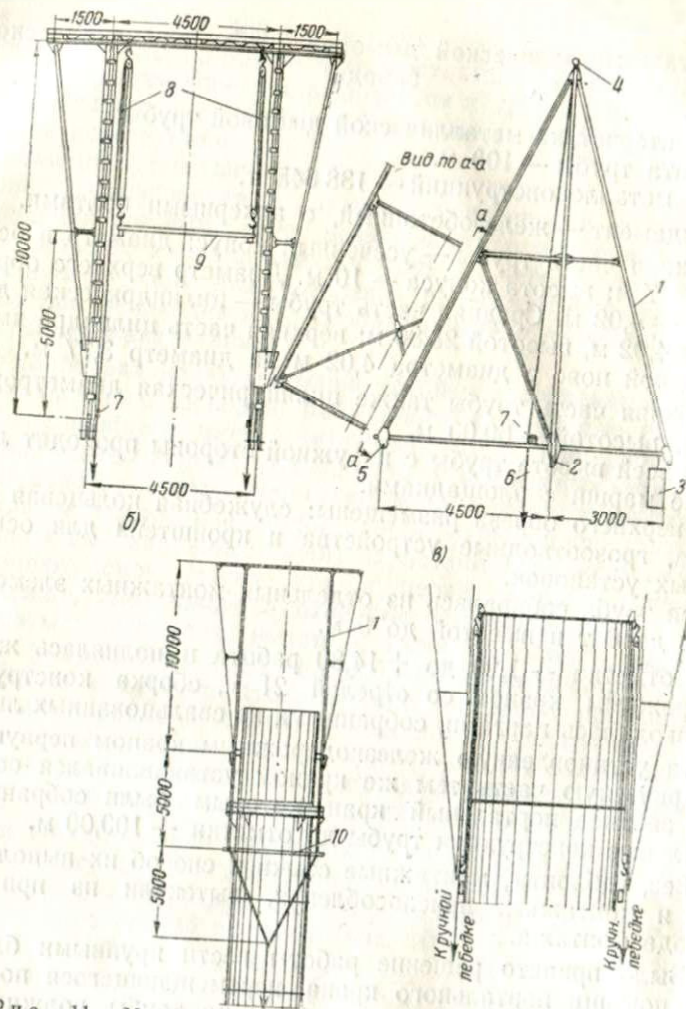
Монтаж дымовой трубы: а — схема порталного крана; б — увязка задней и передней оттяжек; в — схема вертикального перемещения крана ручными лебедками; 1 — стрела крана; 2 — шарнир вращения стрелы; 3 — противовес; 4 — узел крепления груза фермы; 5 — узел крепления троса для подъема; 6 — грузовой трос; 7 — отводящий ролик; 8 — грузовые полиспасты; 9 — траверса; 10 — распорка из трубы
